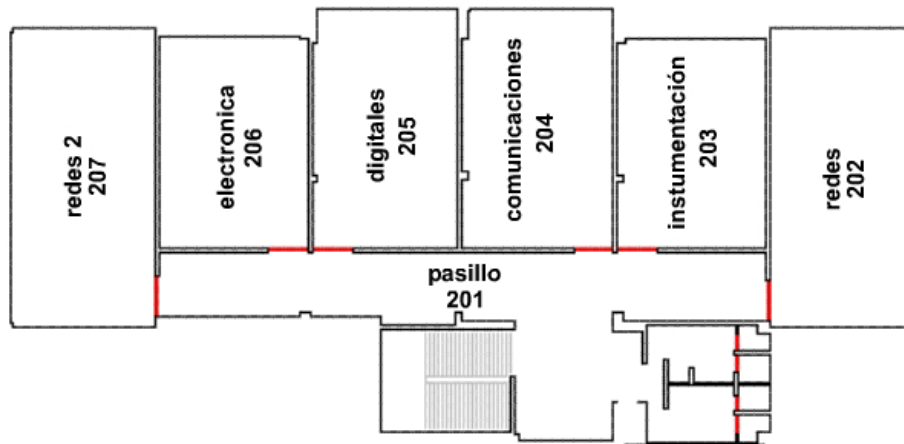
Plano de Planta Edificio de Alta Tensión UIS
